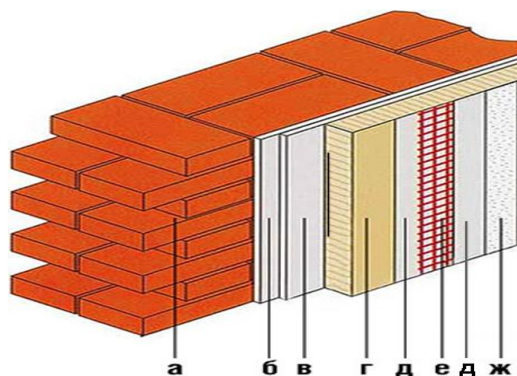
Основные составляющие теплоизоляционной системы для ремонтных и восстановительных работ: а – основание (бетон, легкий бетон, кирпичная или каменная кладка, дерево, металл); б – старая наружная отделка (штукатурка и т. п.); в – внутренний слой предлагаемой отделочной смеси; г – утеплитель (плиты из минерального волокна); д – наружный слой предлагаемой отделочной смеси; е – сетка из стекловолокна; ж – декоративная отделка
